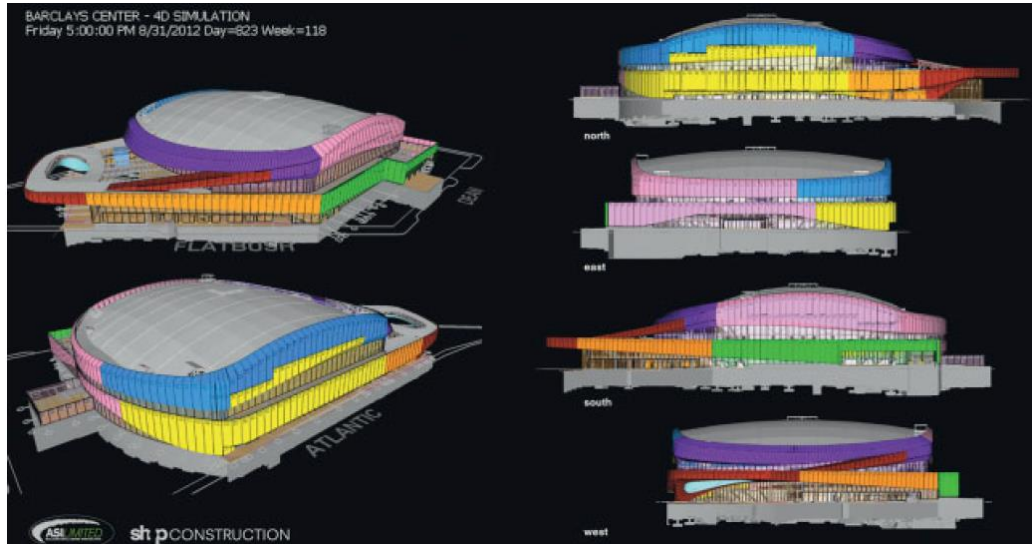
Barclays Center plan şeması (<http-9>)
